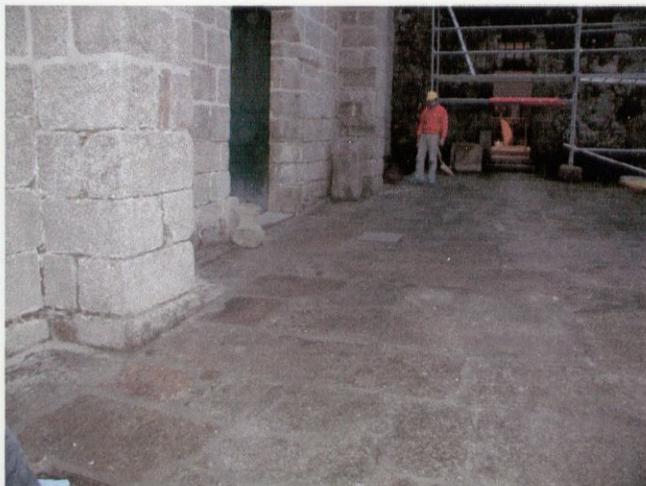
Sector SOA02/02. Vista previa a la excavación de la zanja para drenaje
